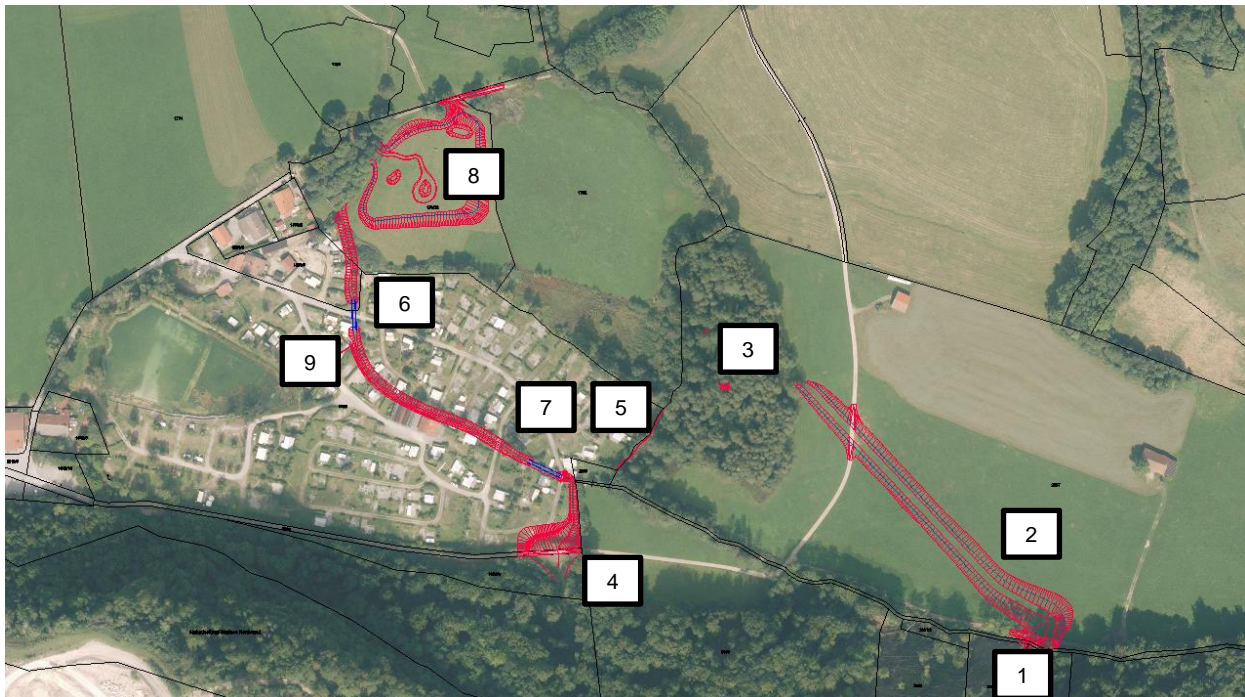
Ausschnitt Lageplan mit den verorteten Maßnahmen (rot) im Zuge des Gewässerausbaus Kothgraben.
